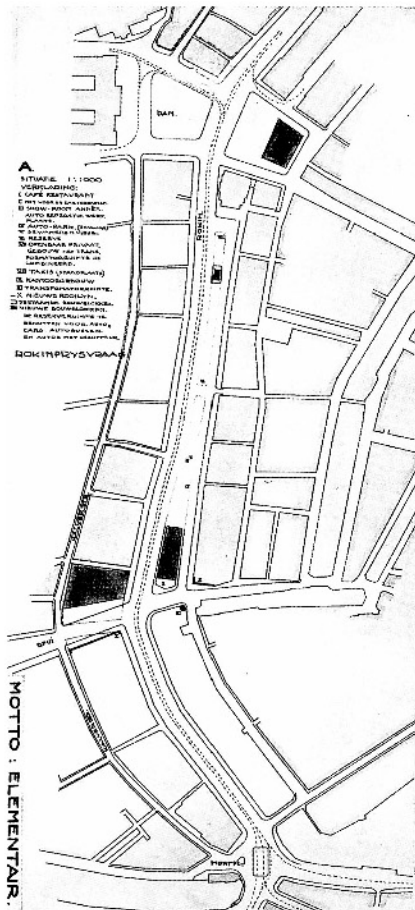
Rokin, Amsterdam, 1924. Planimetría del proyecto
